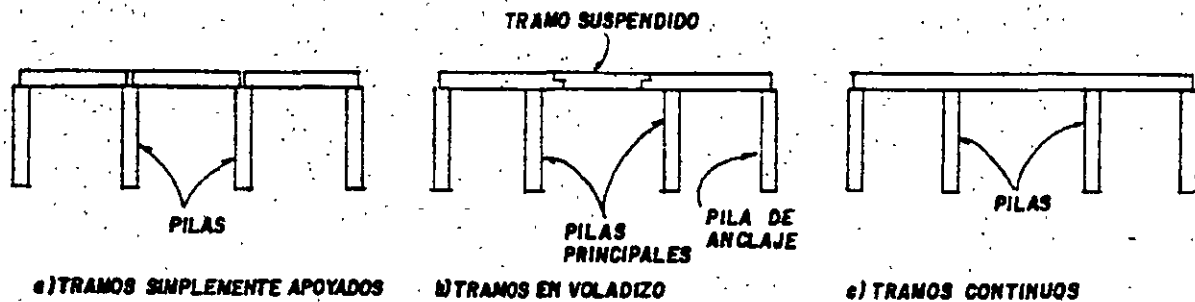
Disposición estructural de los miembros principales de carga de un puente.
